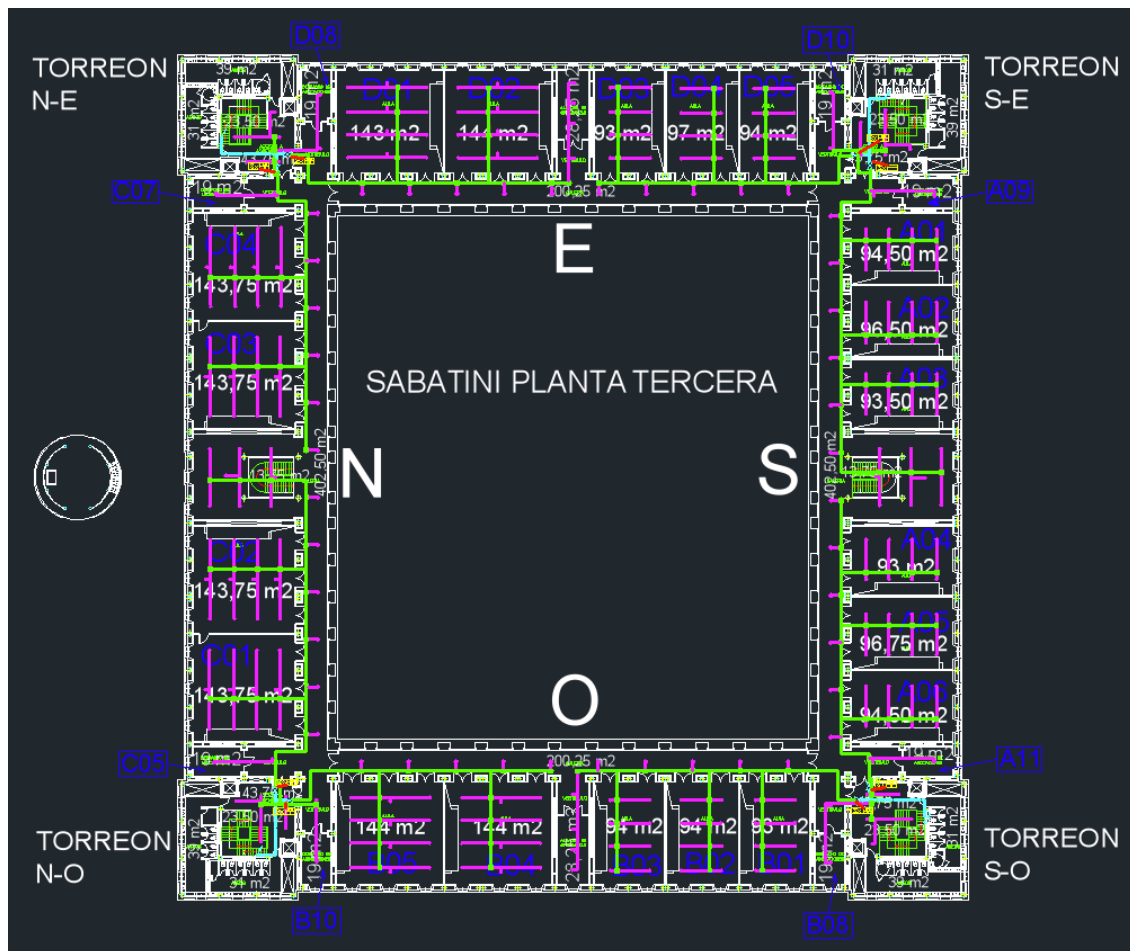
Vista en planta de la planta tercera con la distribución del sistema - AutoCAD
